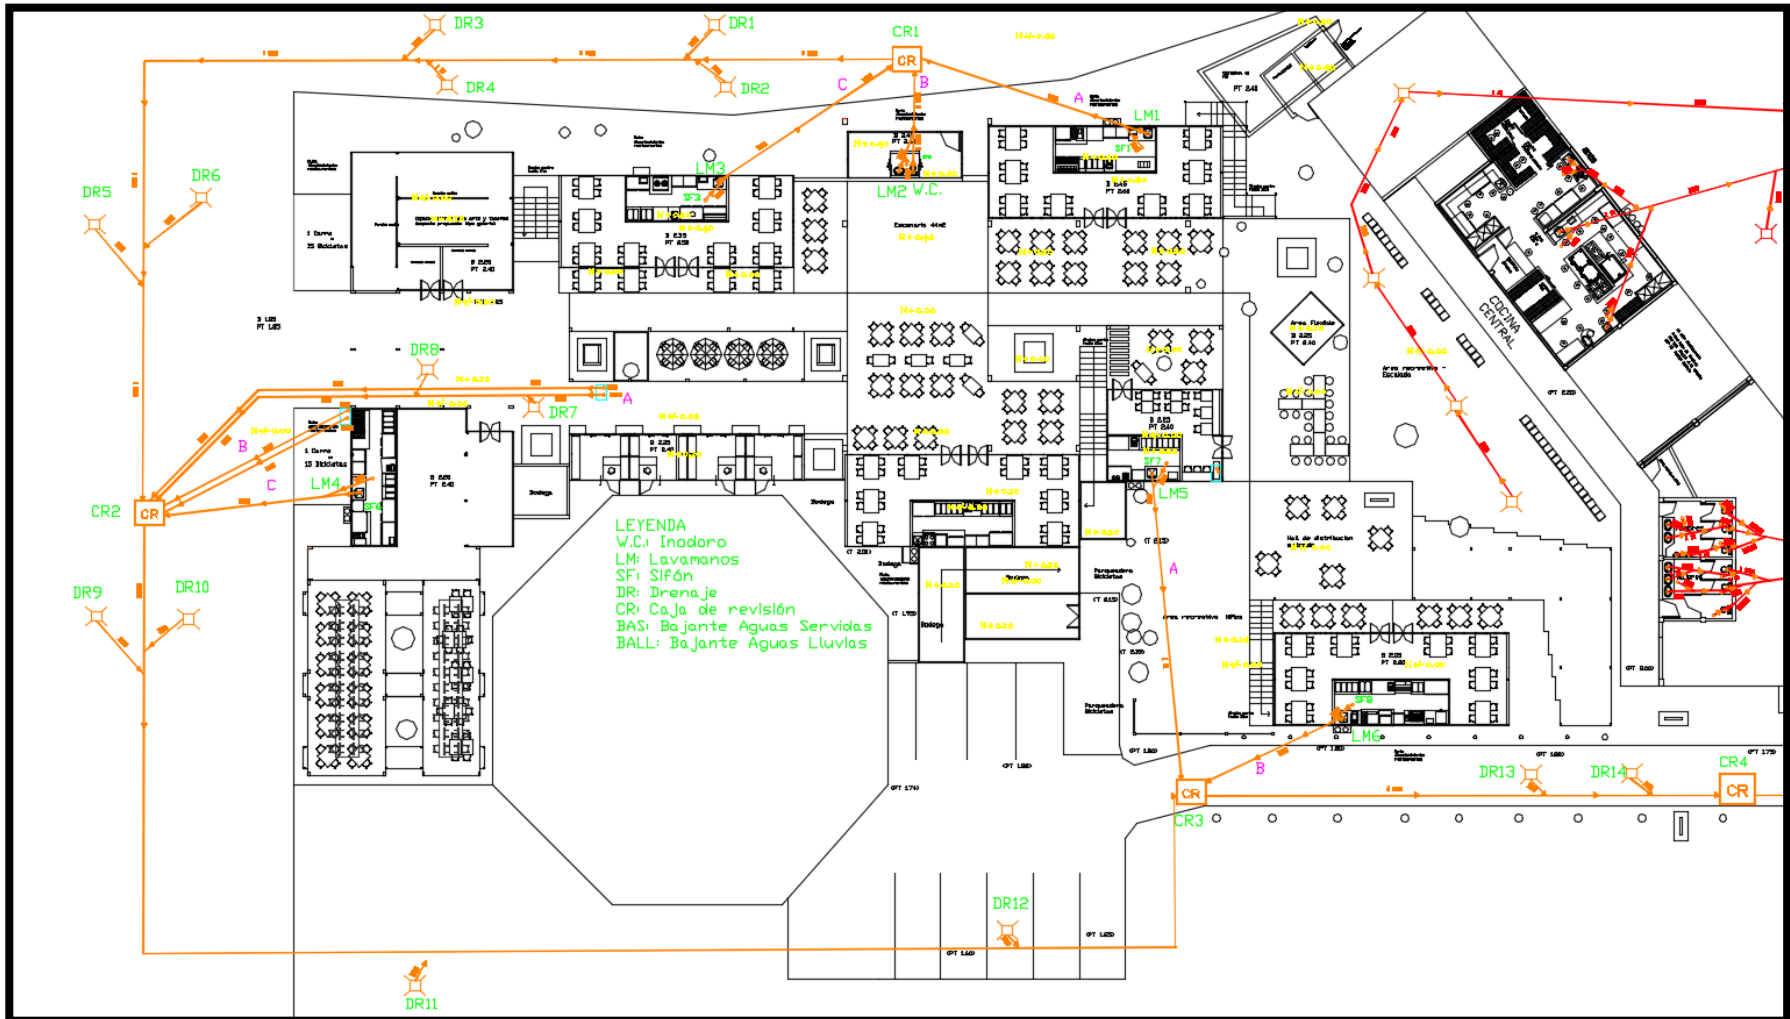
Vista en planta de la red de desagüe del 1er piso de La Galería
